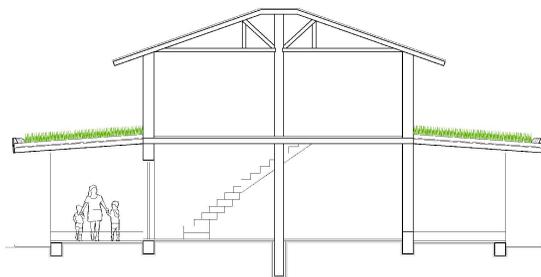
Esquema em corte da residência da família Torres. Telhado vivo na cobertura do primeiro pavimento.
